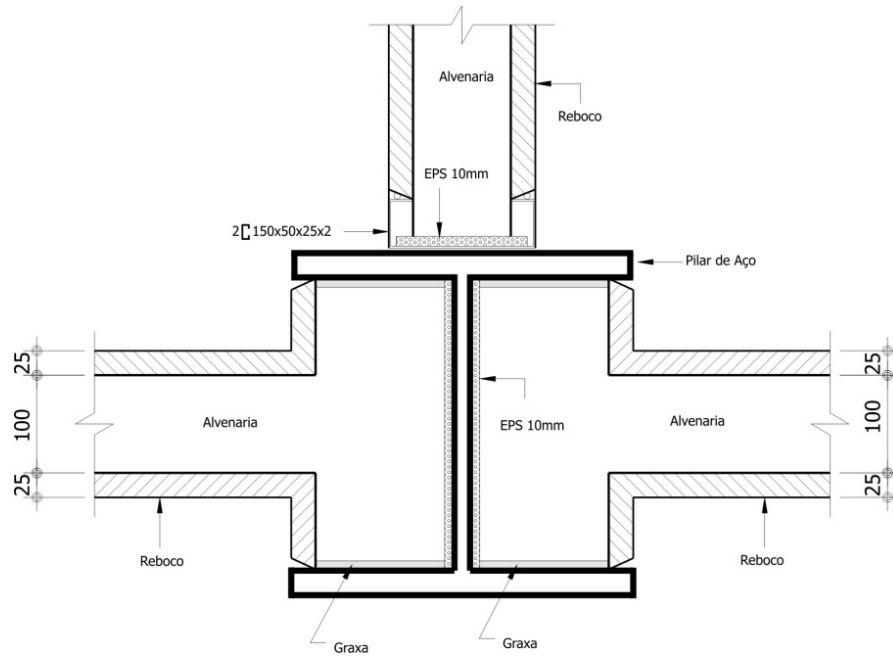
Detalhe de vinculação entre a alvenaria e um pilar de aço.
